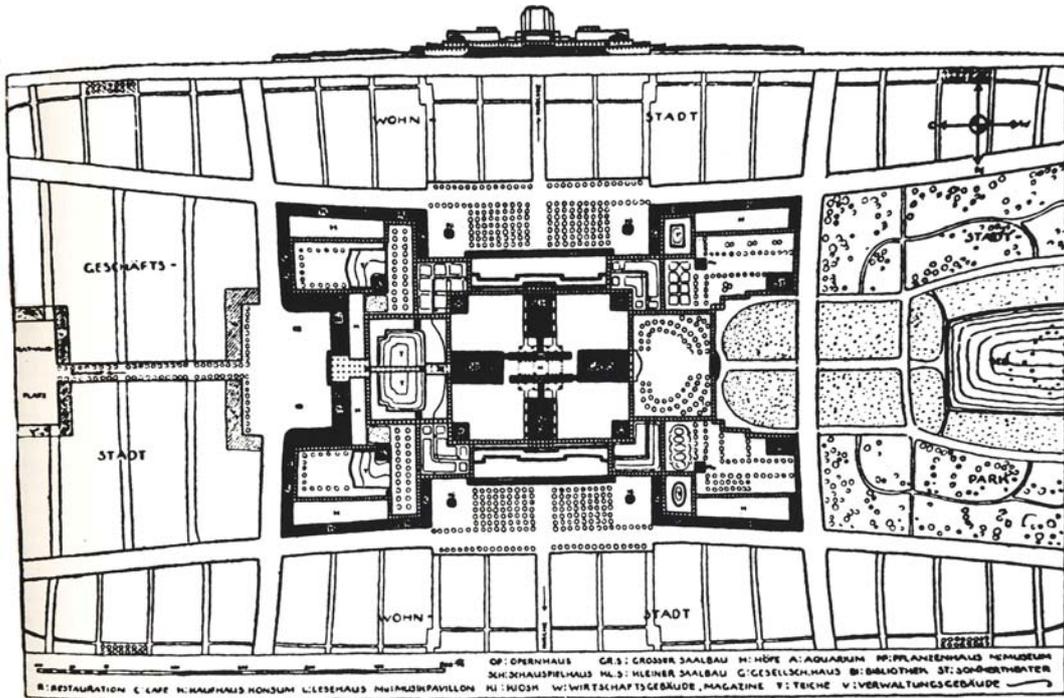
Bruno Taut, Stadtkrone, 1919, Ansicht und Lageplan
